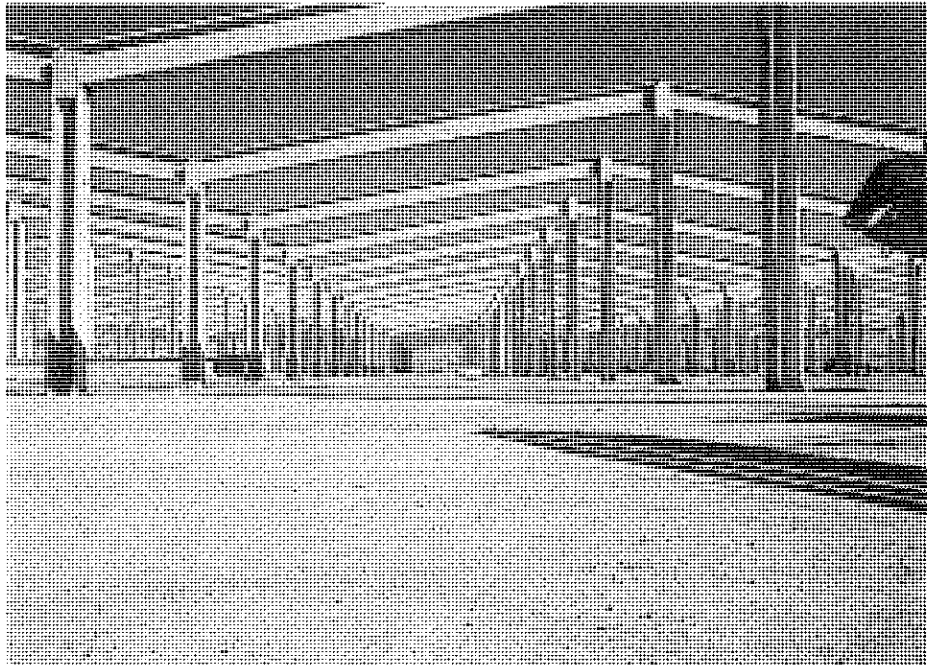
Sistema elemental de pilares y jácenas, prefabricado por PACADAR.
